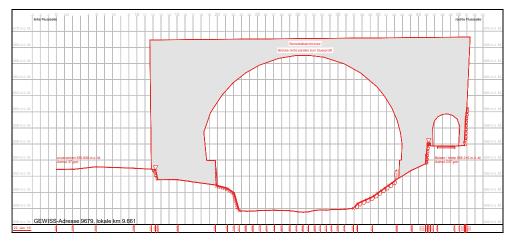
Exemple 2 profil d'espace libre, profil en travers
